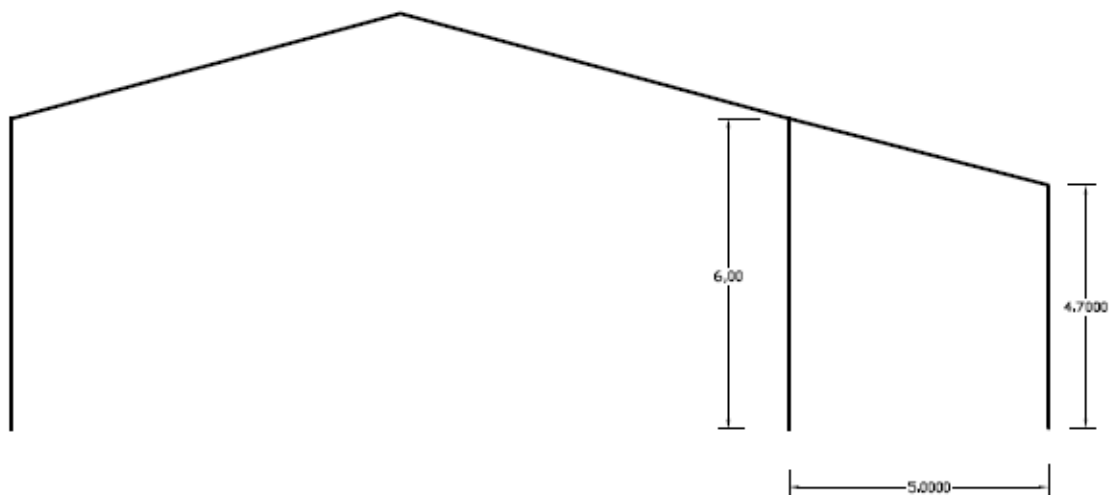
Croquis de las dimensiones de los pórticos metálicos que componen la estructura del sotechado para la astilla.
